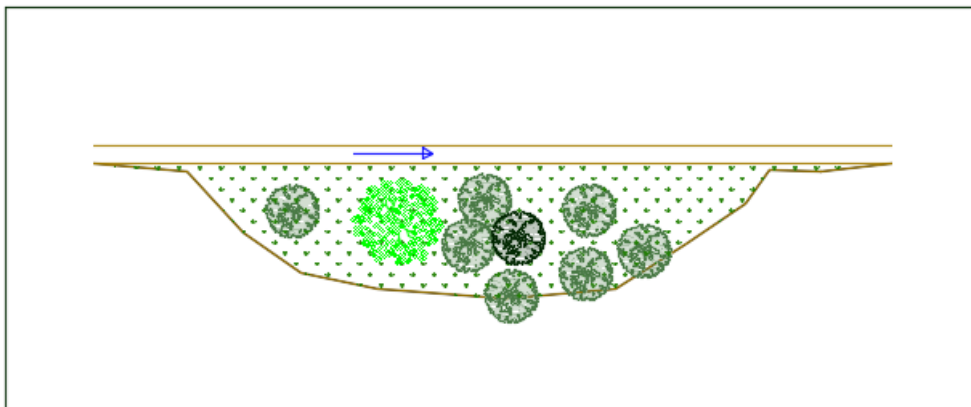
schema del progetto di piana inondabile per la laminazione delle piene
